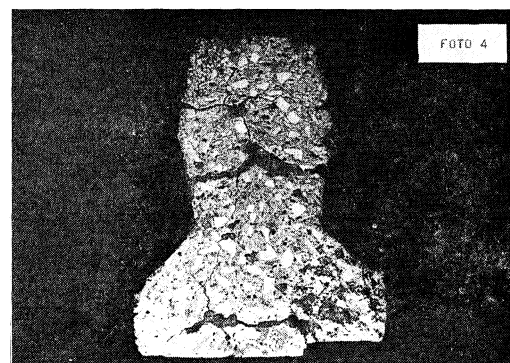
Vigueta semirresistente de hormigón pretensado, confeccionada con los áridos de referencia.
